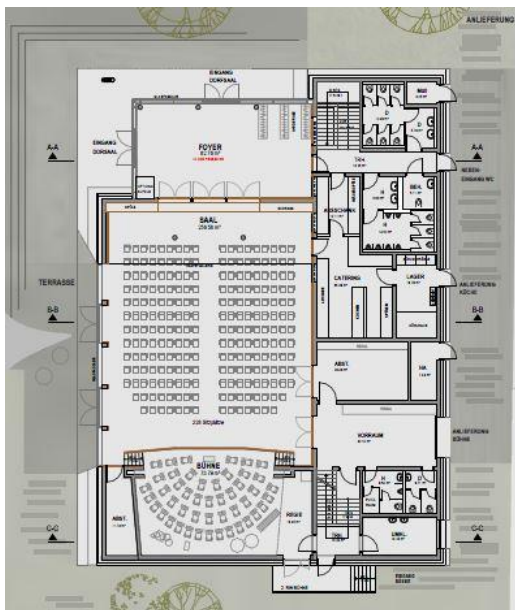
Saalgrundriss : © Creaplan Metzler, Stand: Februar 2019 ohne Maßstab
